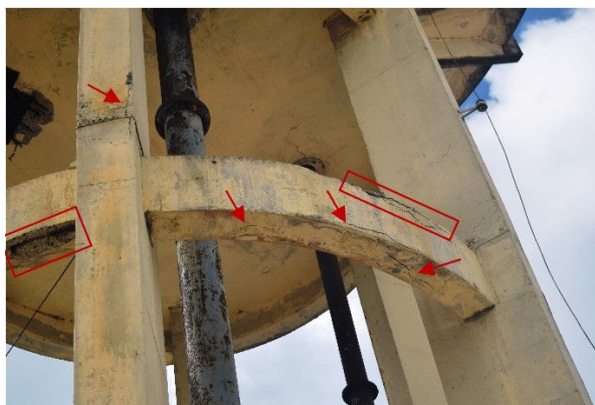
Detalhe da viga de 2º nível com corrosão da armadura (retângulos) e zonas trincadas com iminente deslocamento do concreto (setas)
